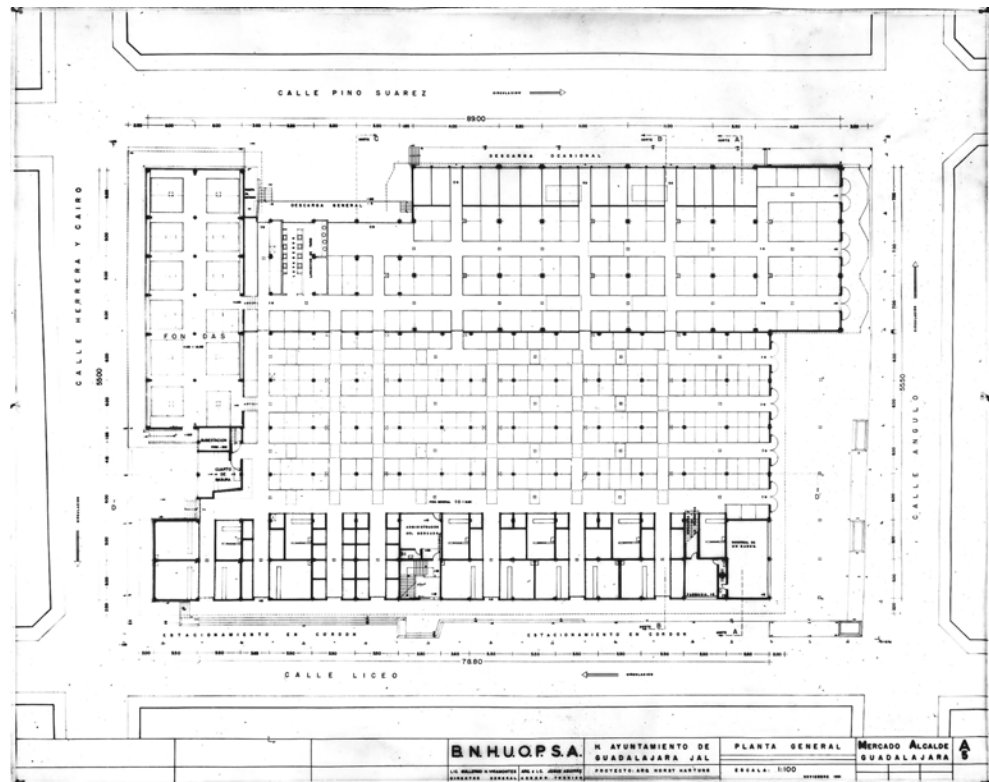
Mercado Alcalde, Grundriss Erdgeschoss (Planta General)
